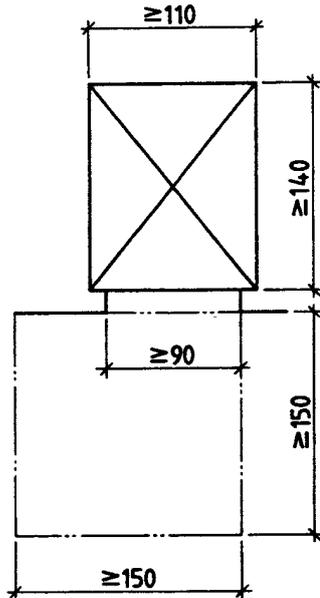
Lichte Maße des Aufzugsfahrkorbs und Bewegungsfläche vor den Fahrschachttüren
